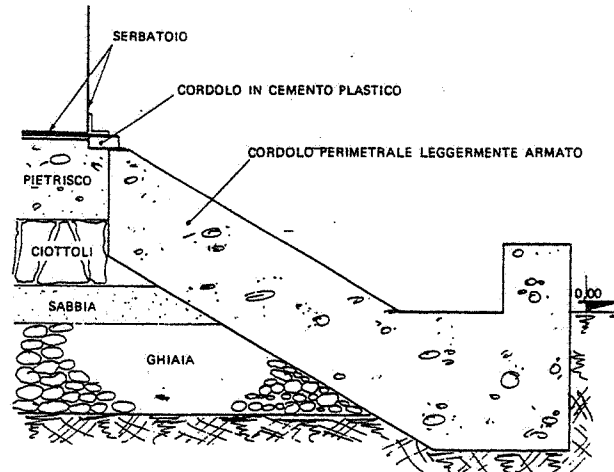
Esempio di fondazione per serbatoi cilindrici ad asse verticale fuori terra.
